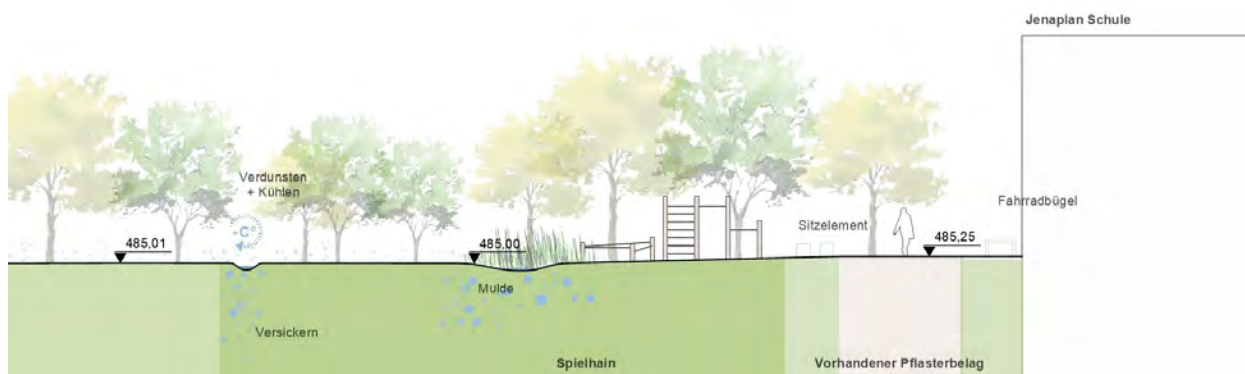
Planausschnitt Vorentwurf Gebäudenaher Pausenhof Jenaplan Schule (Anhang Plan 1.1), Schnitt (Anhang Plan 1.2) (faktorgrün, 2025)
